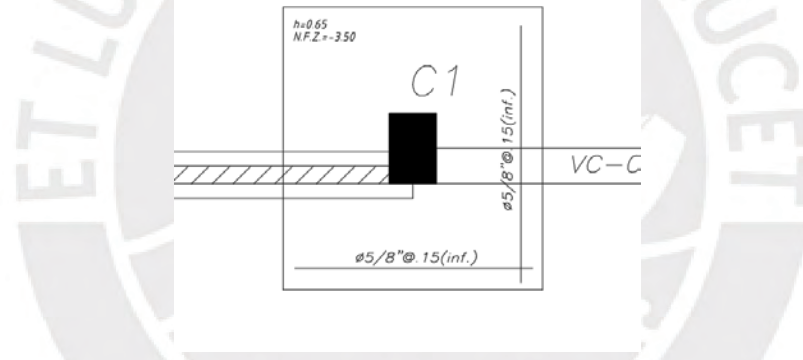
Diseño final de la zapata C-1 para sistema de muros
